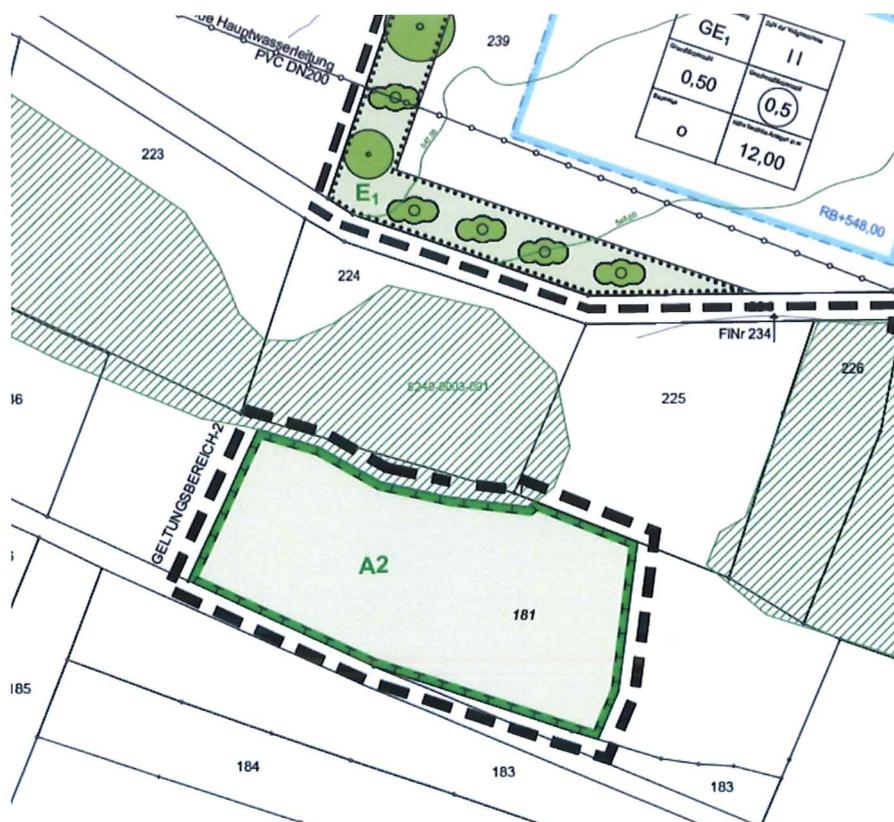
Lageplan Ausgleichsfläche A2, Fl.Nr. 181 (ohne Maßstab)
